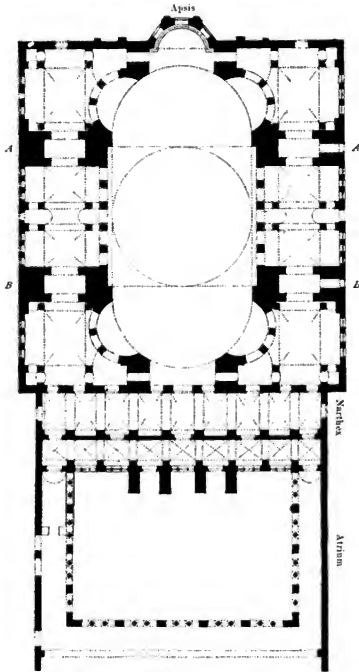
Sophienkirche zu Konstantinopel. Grundriss.
